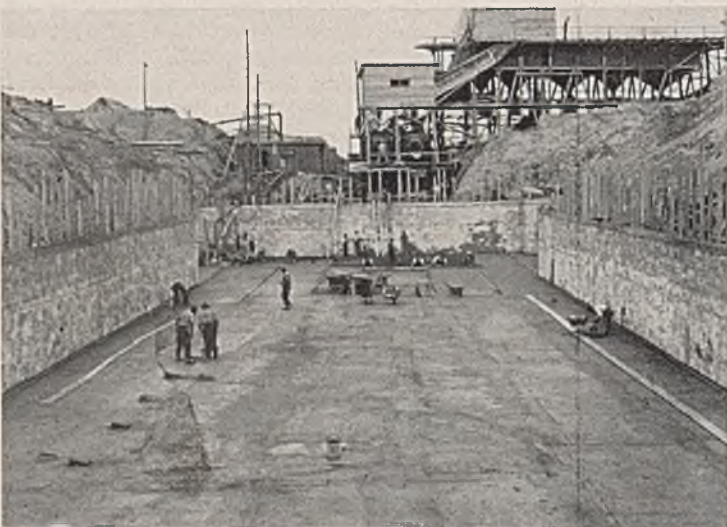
Schleusenbaugrube Sandhof vor dem Einbringen der Sohle.
